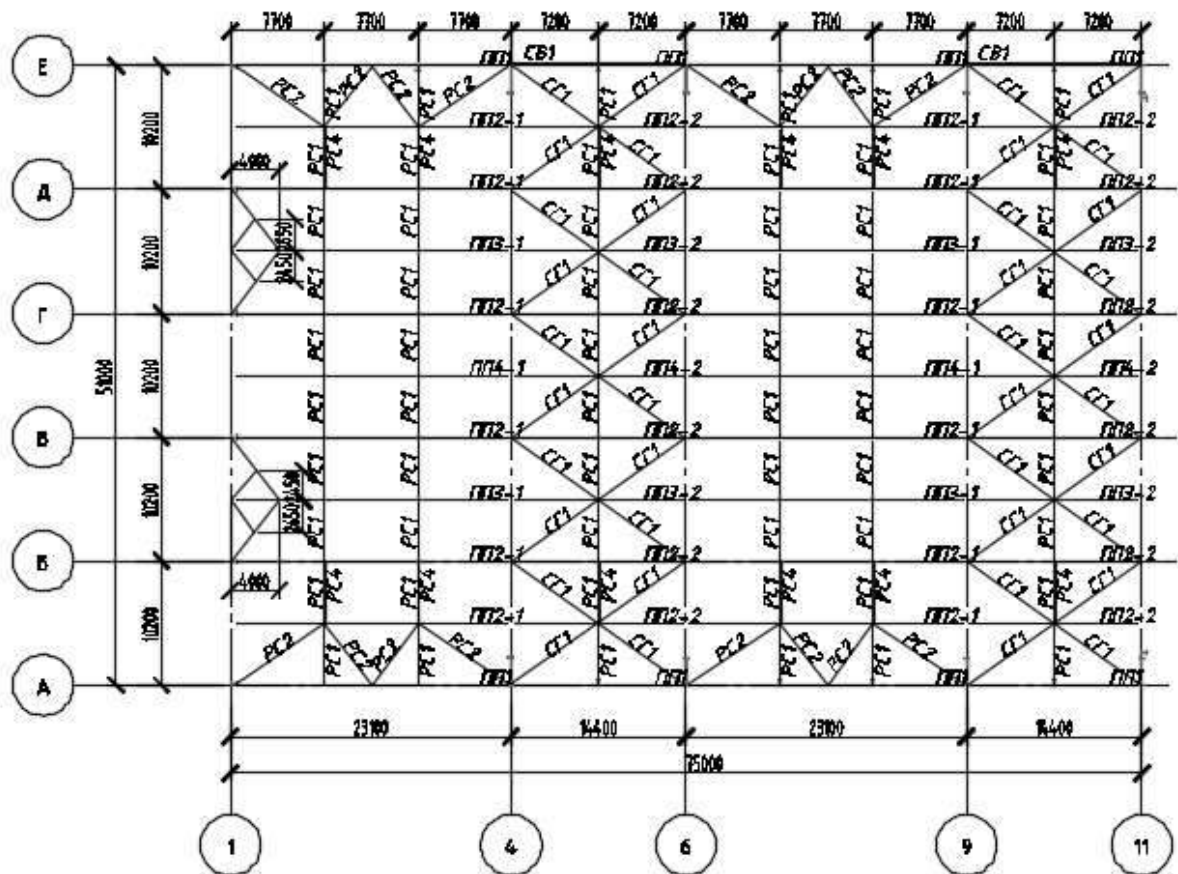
Схема конструкций по верхней балке покрытия
